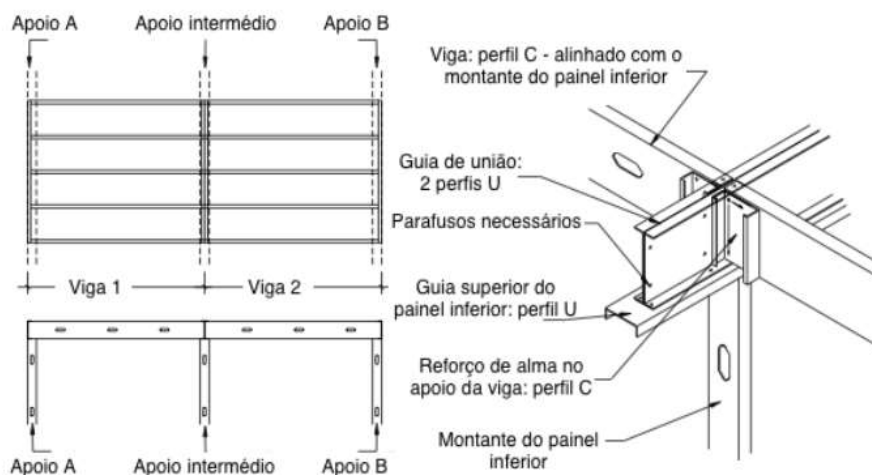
Detalhamento de vigas simplesmente apoiadas [1].
